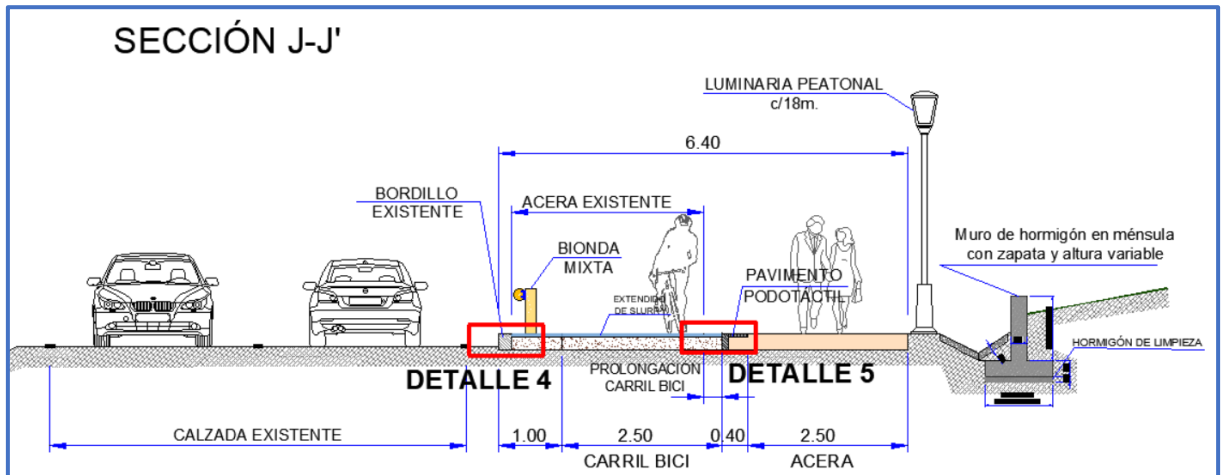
Sección transversal con bionda mixta y conversión de la acera existente en carril bici con ampliación de sección y capa de slurry de color negro y muro en ménsula de hormigón armado.
